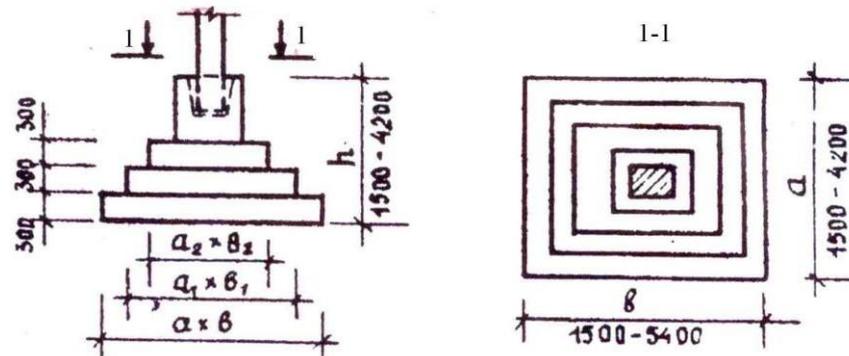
Конструкция железобетонных фундаментов под колонны промзданий
